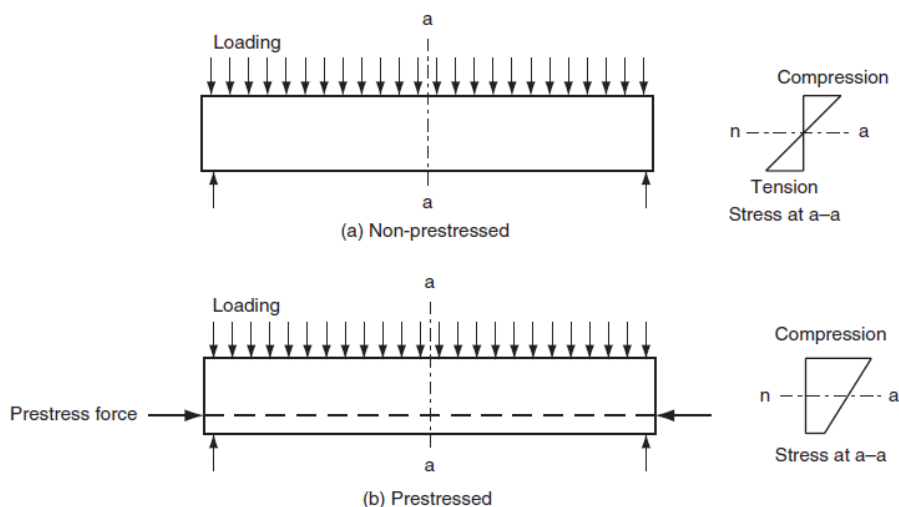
Esquema de viga pretensada con carga uniformemente distribuida [1]
